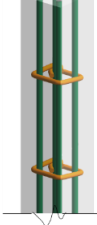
Pemodelan Struktur Beton dan Tulangan
